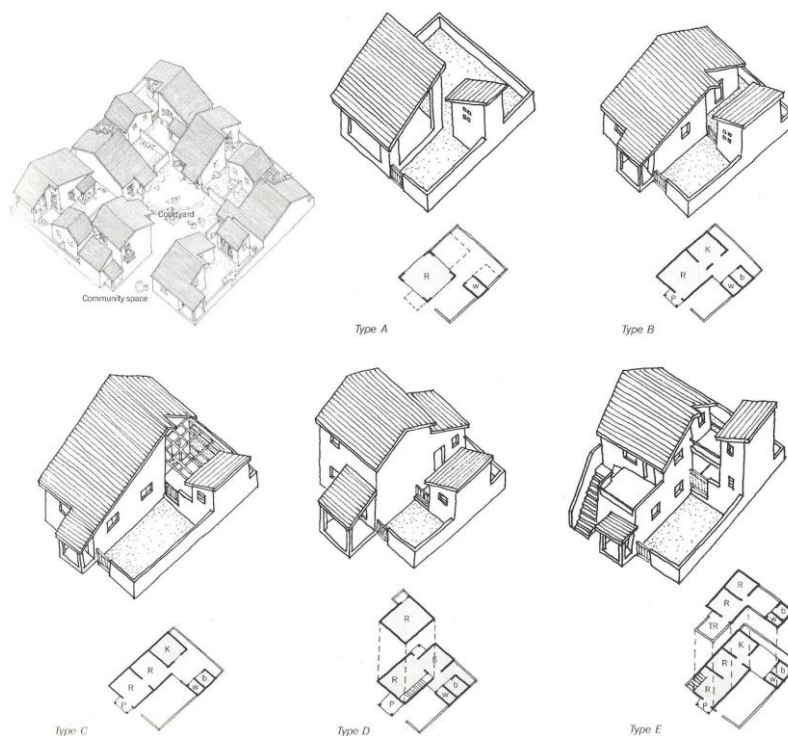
Plano de planta y axonometrías. Belapur Housing
